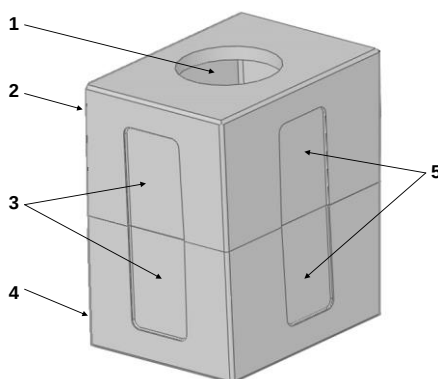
Детали колодца «ККСр-2,5-10(80)» в сборе:
